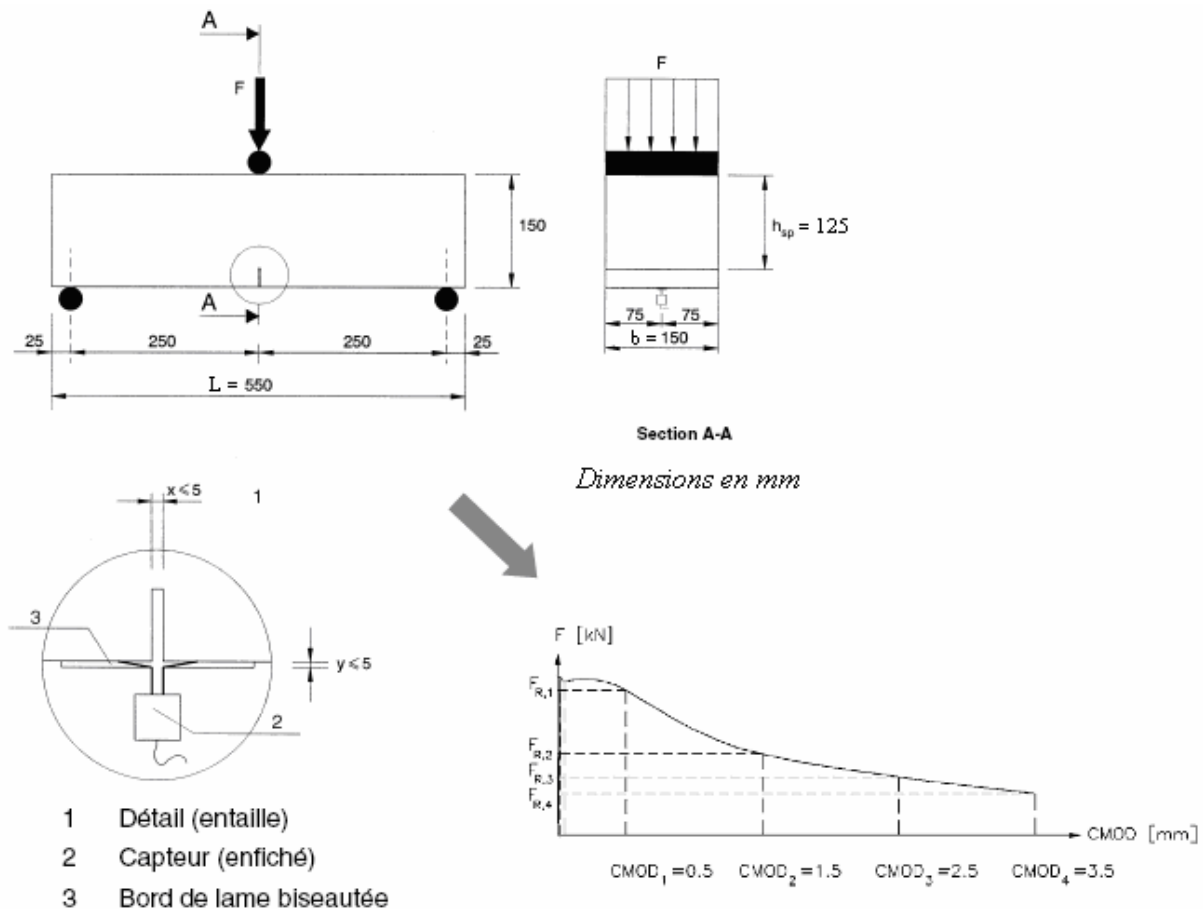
Caractérisation du comportement post-fissuration en traction d'un béton fibré : Essai de flexion 3 points sur prisme 15cm\*15cm\*55cm entaillé (EN 14651, 2007)
